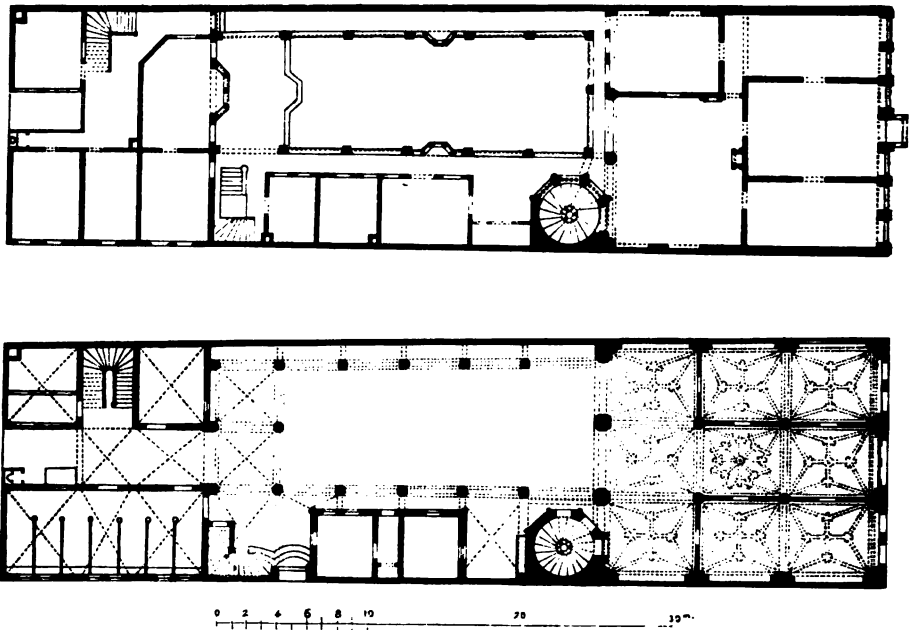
Peller'sches Haus. Nürnberg. Grundrisse des Erdgeschosses und des I. Stockes. (Ortwein.)
